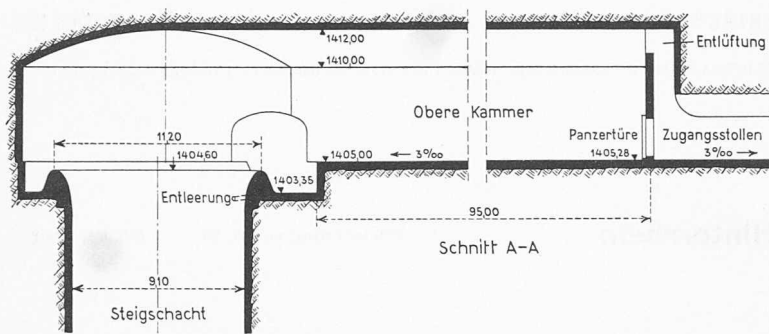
Wasserschloss Sils, Schnitt 1:200. Das Expansionsbecken ist mit einem Ueberlaufschacht und Durchlässt am Schachtfuss ausgerüstet
